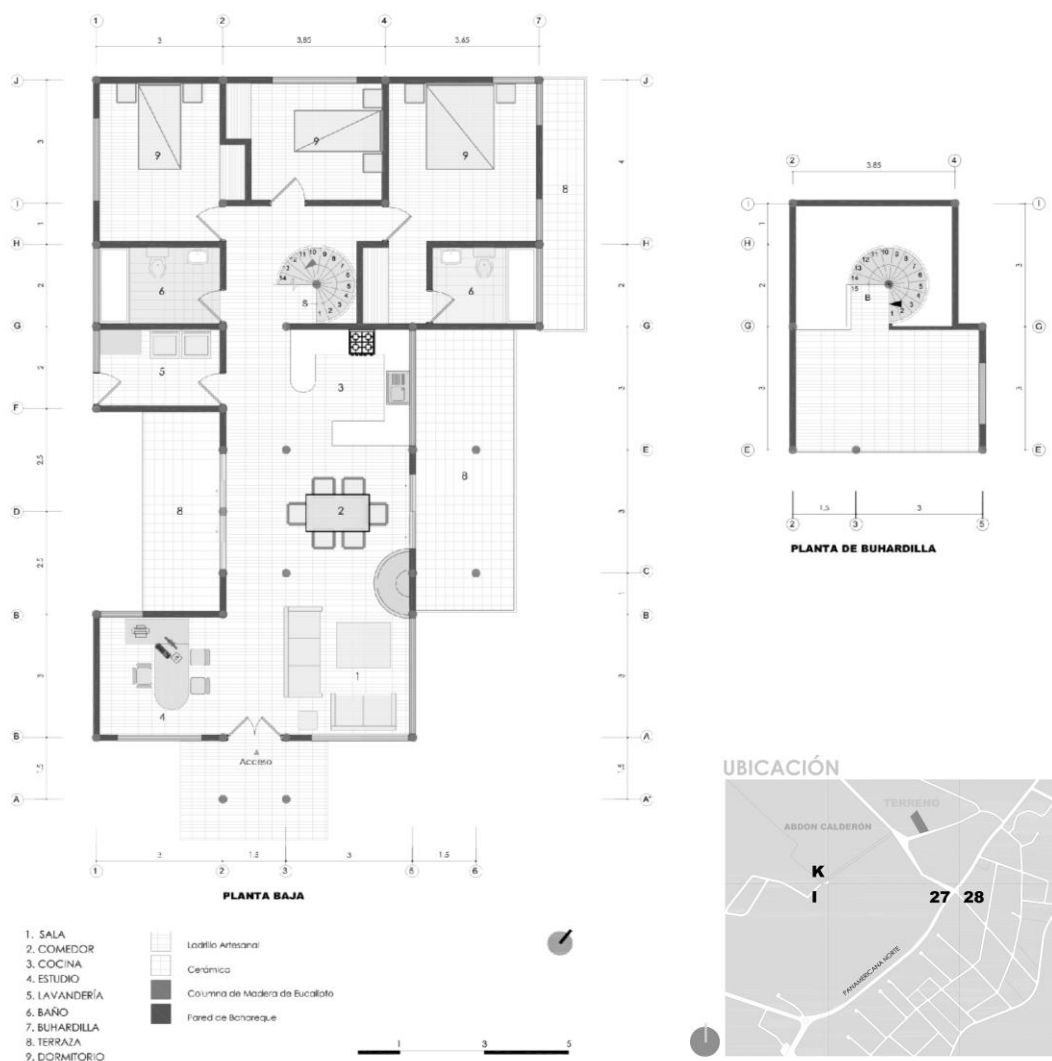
Plantas Arquitectónicas de la vivienda propuesta
